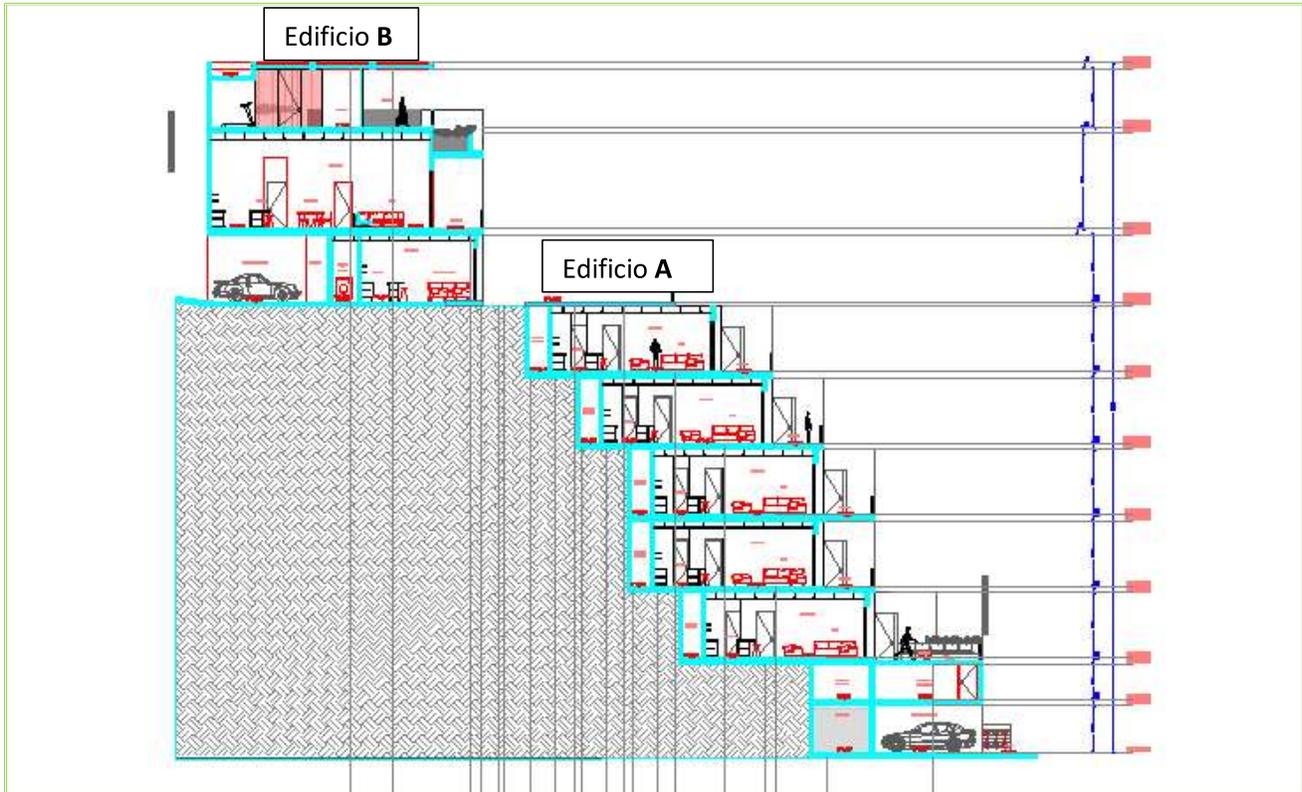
Corte longitudinal del proyecto, Edificio A y Edificio B
